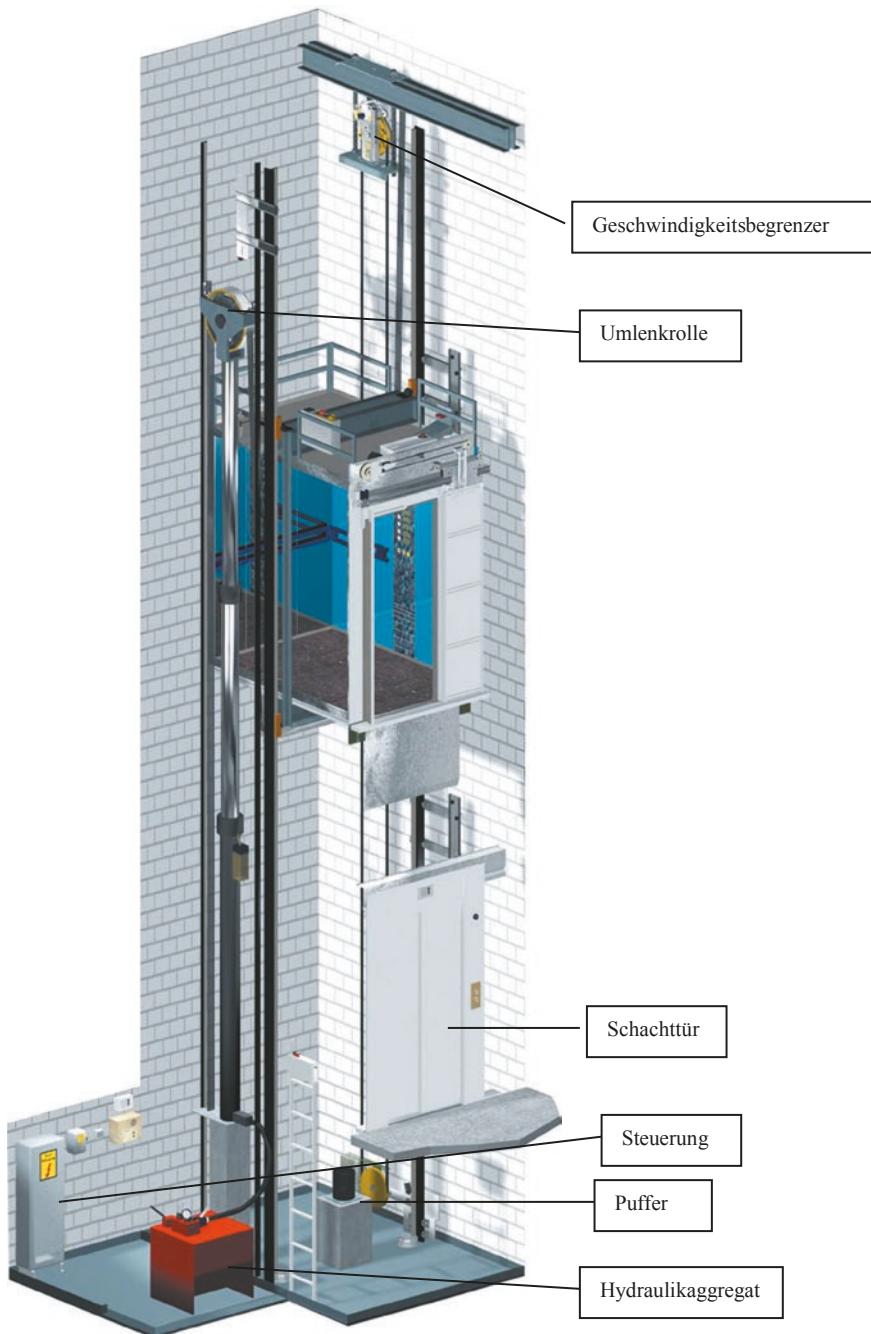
Hydraulisch angetriebener Aufzug mit Maschinenraum (Quelle: Schindler Aufzüge und Fahrstufen GmbH, Berlin)
